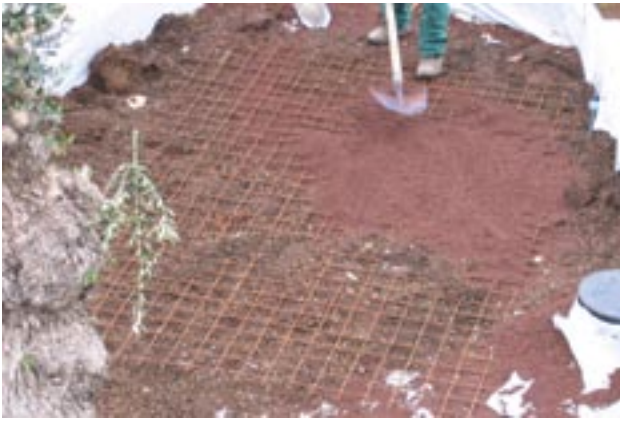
Figure-serie III.34: Ancoraggio di una pianta ad alto fusto
